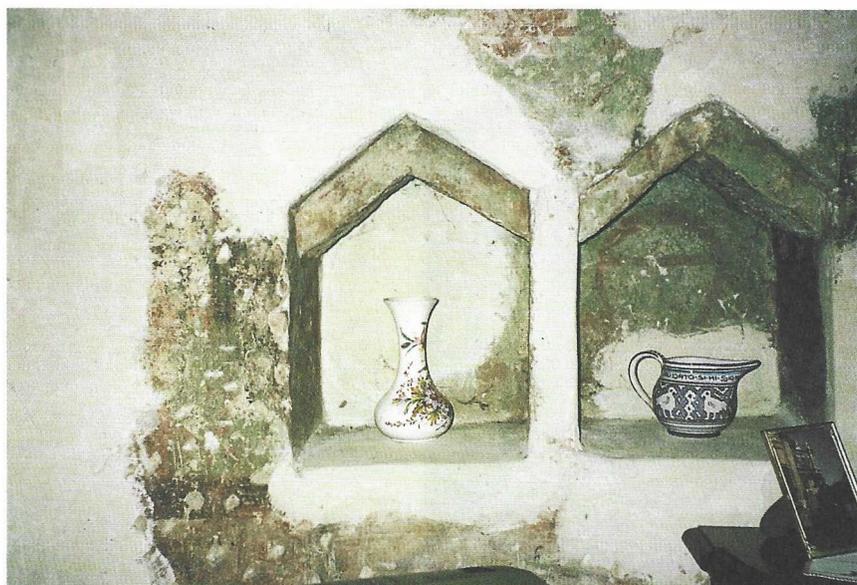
Piazza Canonica di San Pietro, n.11, primo piano, interno, particolare del muro f.
